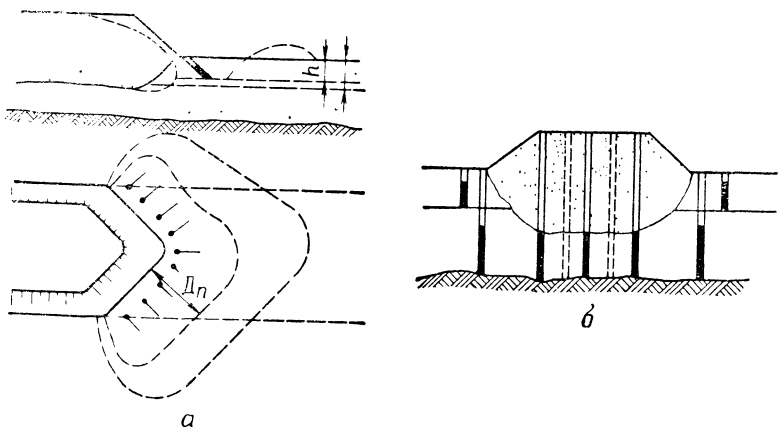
Схемы выторфовывания при посадке насыпей на минеральное дно болот:
